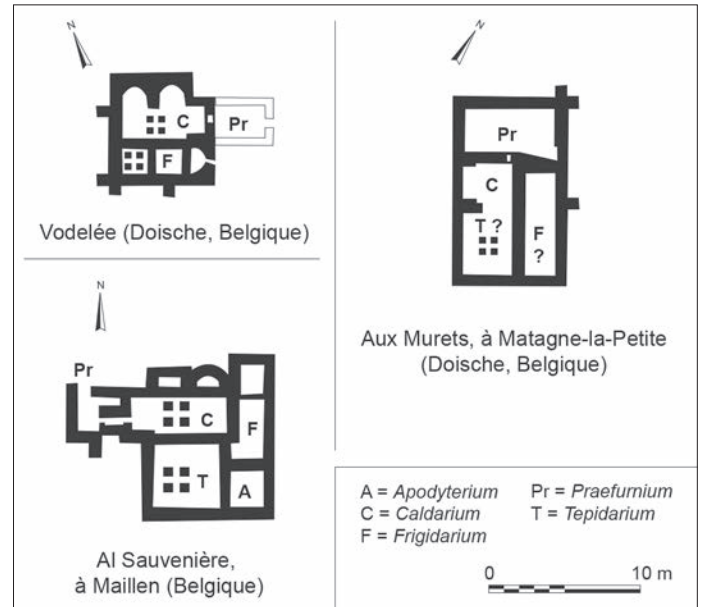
Les thermes construits selon un plan resserré (DAO : D. Labarre).
